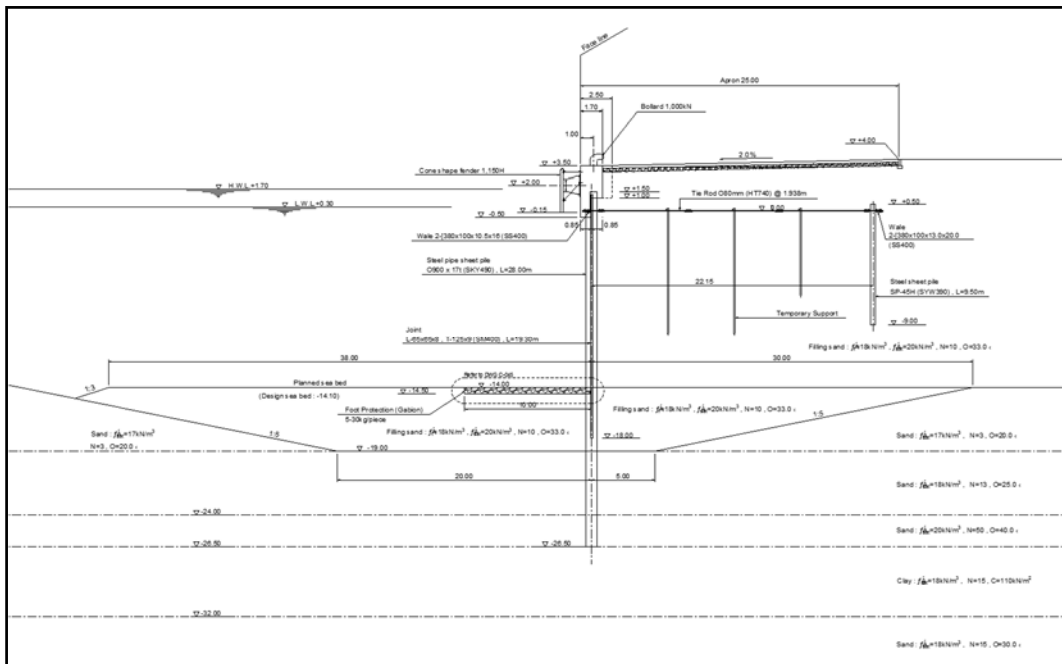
Profil type du nouveau quai ouest de -14 m (L=300 m)
